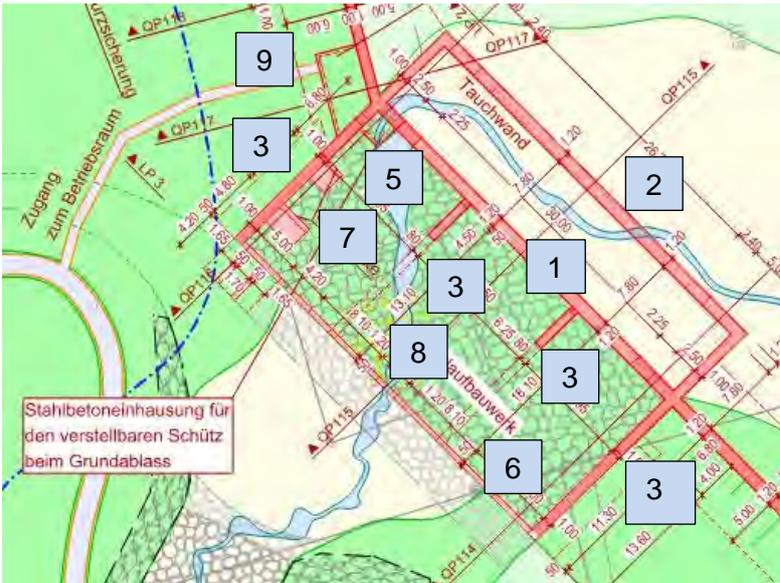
Grundriss des Auslaufbauwerkes I (Quelle: Schubiger AG)
